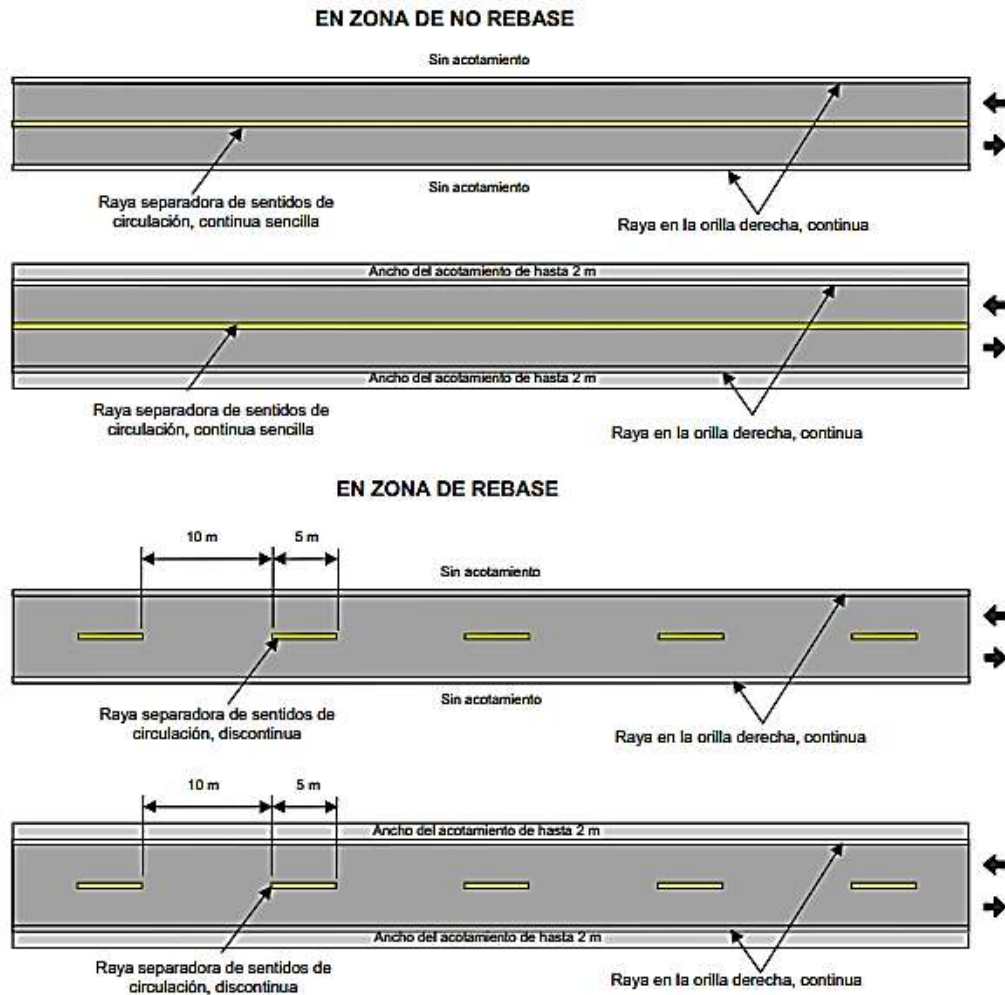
Marcas en el pavimento en carreteras con ancho de calzada de hasta 6.5m
